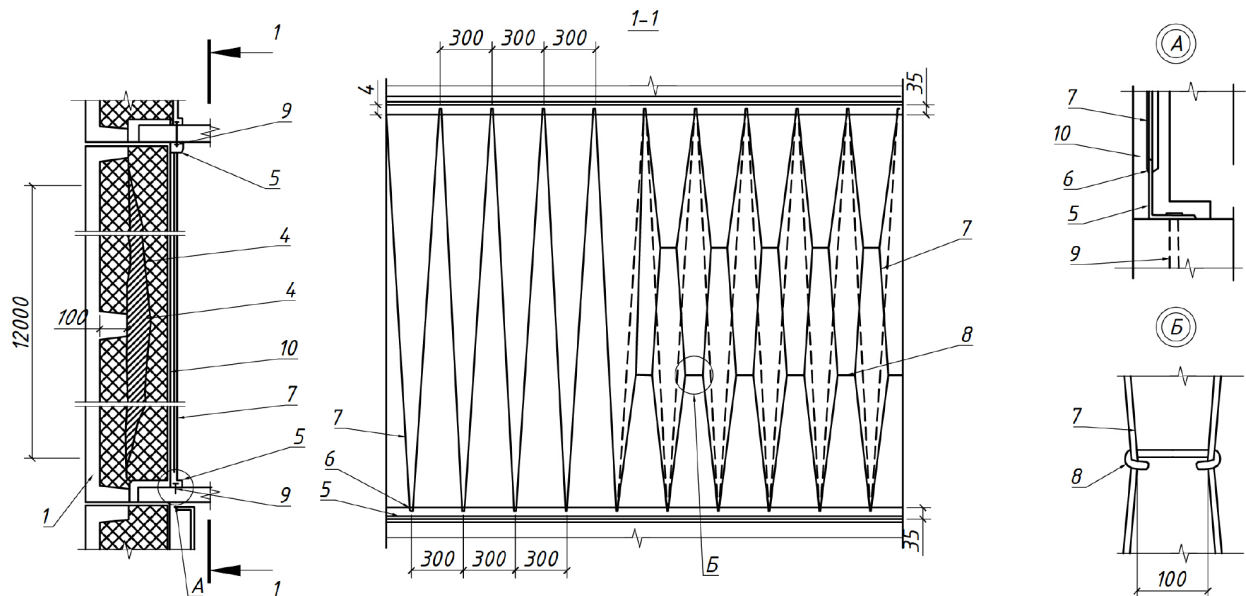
Ремонт утеплителя стеновых панелей. Разрез по существующей наружной стеновой панели: 1 – железобетонный каркас панели; 2 – существующее перекрытие; 3 – существующий утеплитель с образовавшимися пустотами; 4 – пустоты; 5 – опорный уголок 35×25×2; 6 – отверстие 5 мм, шаг 300 мм, для пропуска проволочного каркаса; 7 – проволочный каркас 3 мм; 8 – скоба из проволоки 5 мм; 9 – дюбель-гвоздь 4,5 мм,  $L = 50$  мм; 10 – гипсоперлитовая штукатурка
